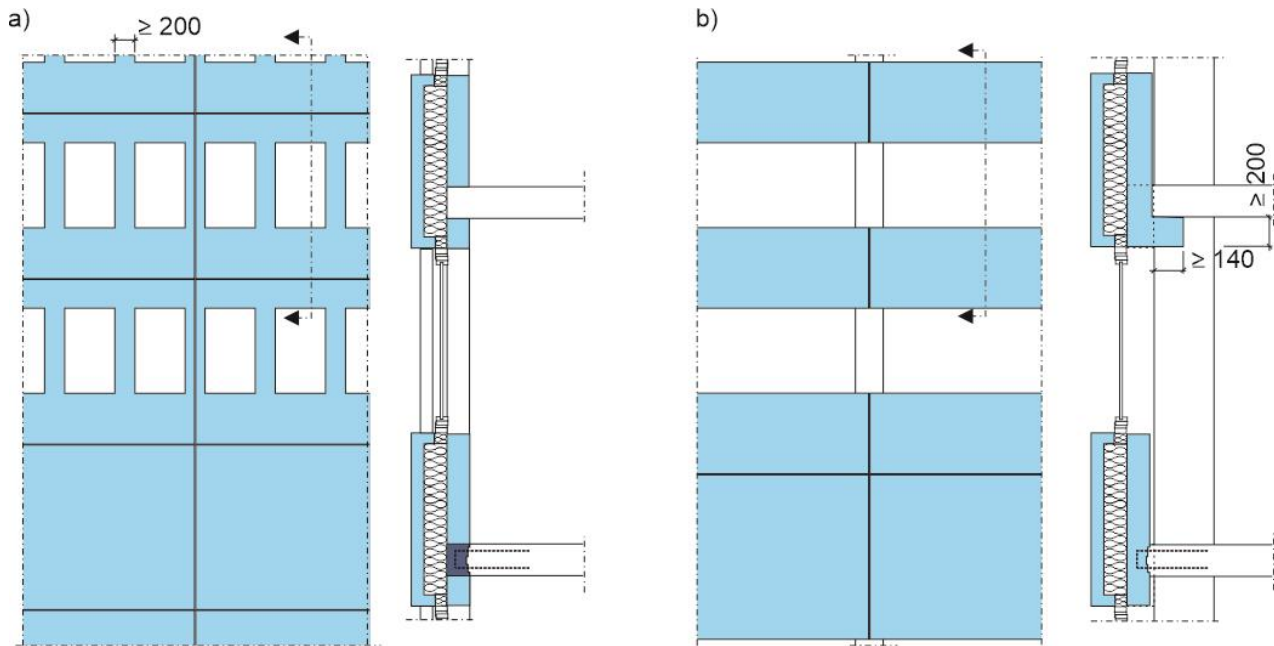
Schematische Ansichten und Fassadenschnitte bei zwei Tragwerksarten a) Fassade mit direkter Lastabtragung (hier: Lochfassade, b) Fassade mit Lastabtragung durch Stützen (hier: Bandfassade)
